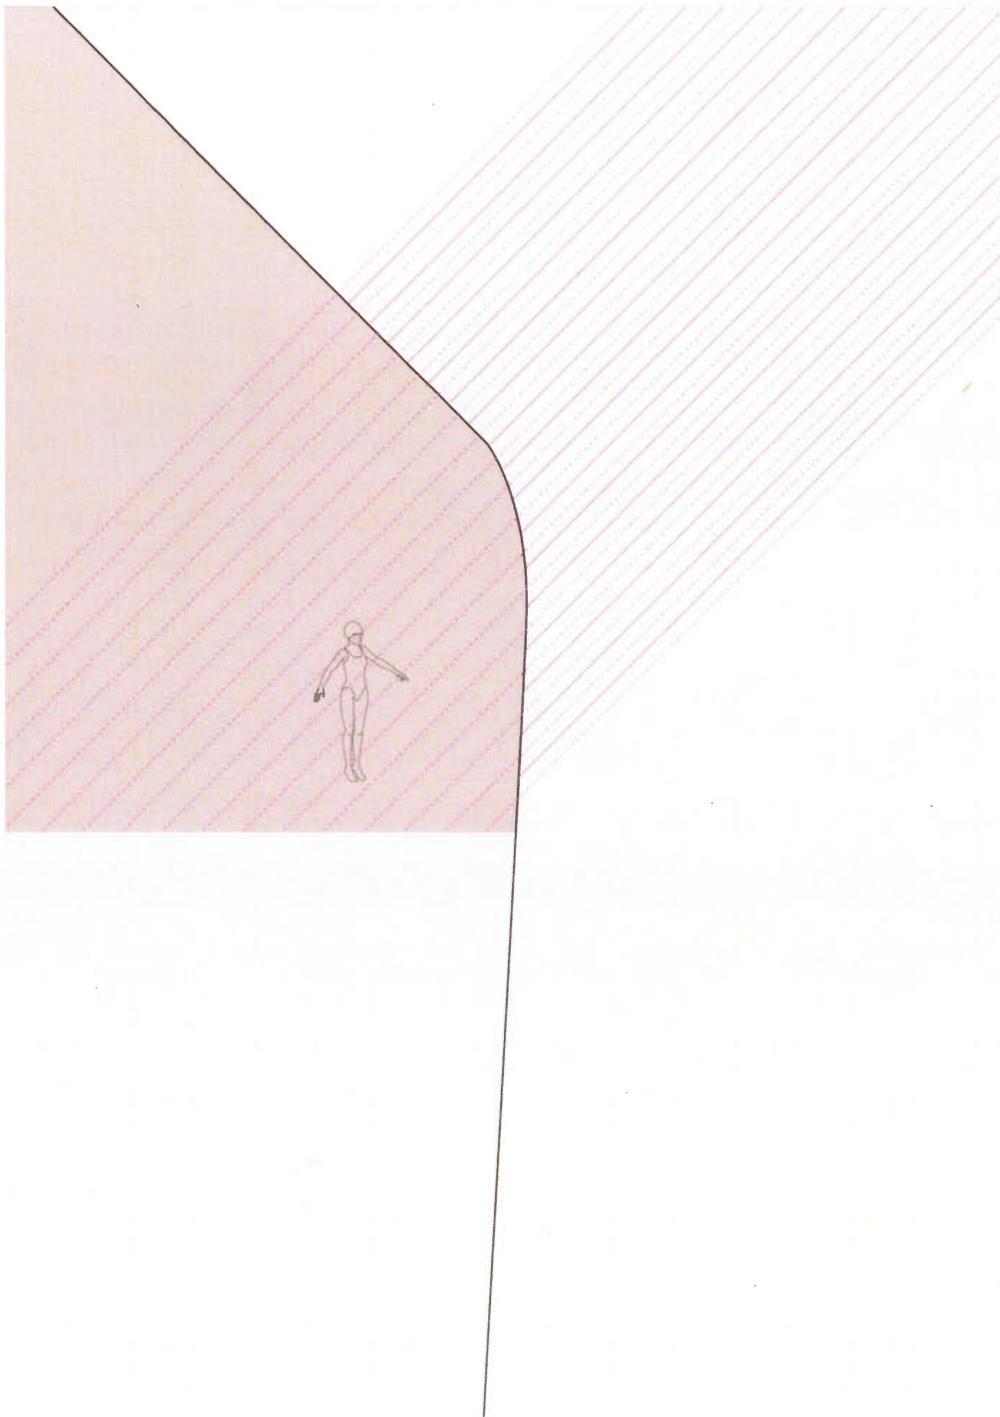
F - déplacement de la toiture - modification du rapport en extérieur et intérieur
